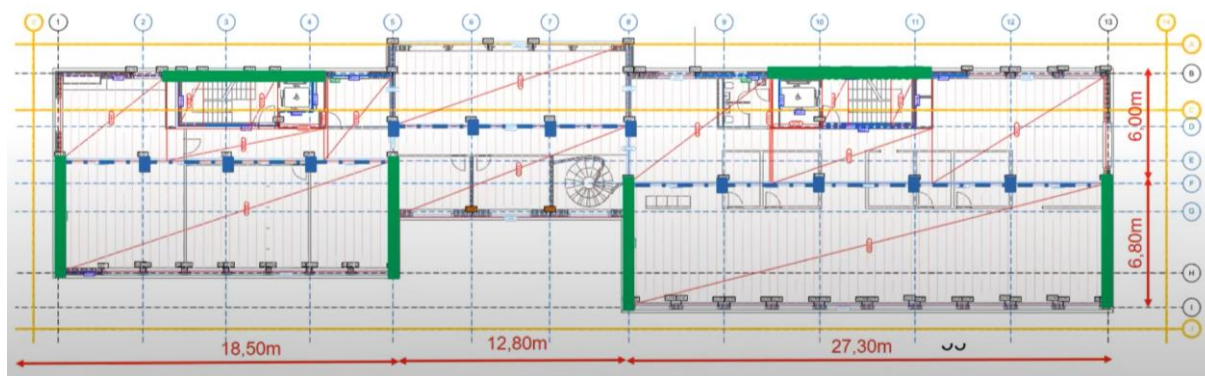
Haus des Holzes - Grundriss Tragwerk (aus [121])
